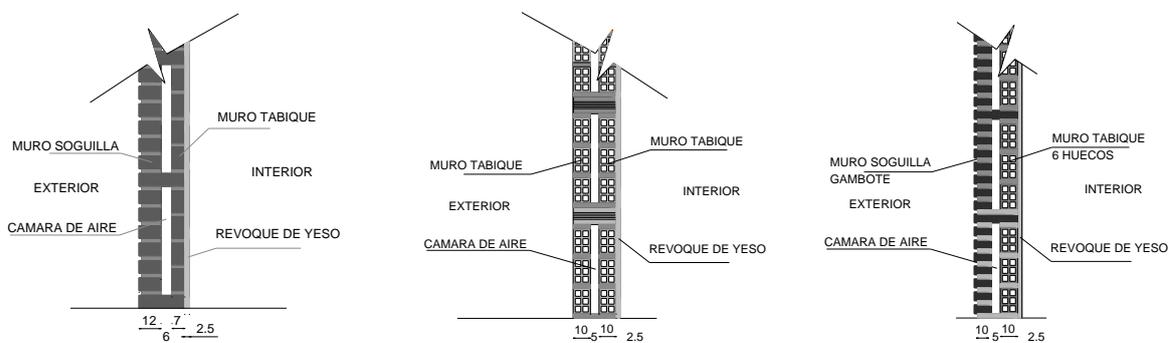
Muros exteriores con aislamiento térmico para paredes lado S, SE y SO.
